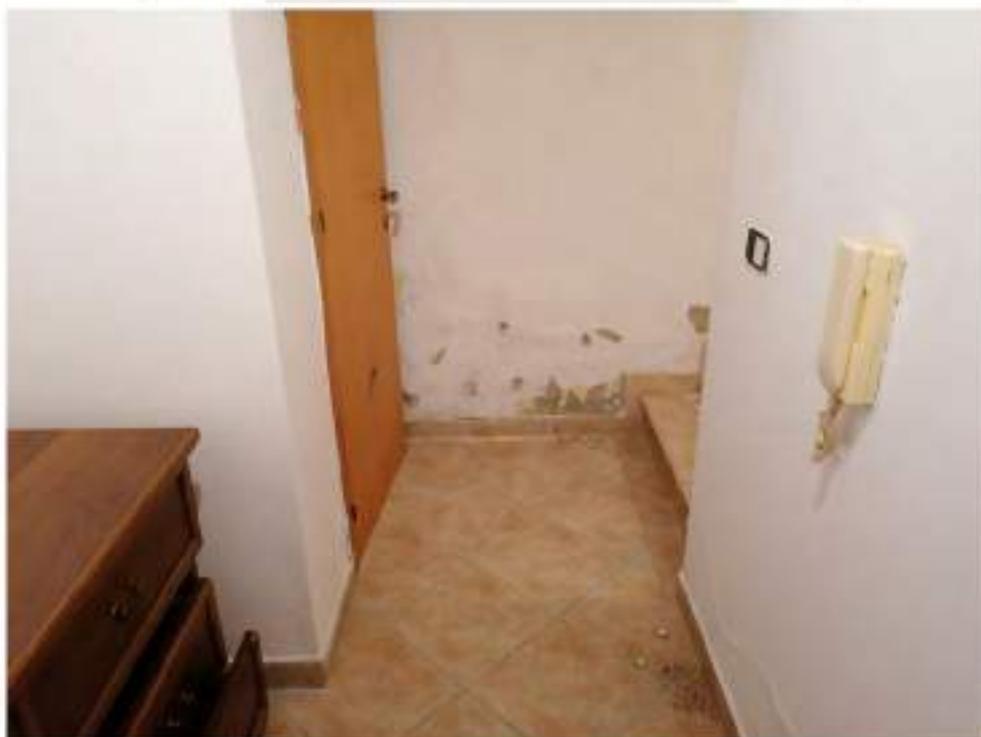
Vista interna piano sottostrada appartamento sub 8
